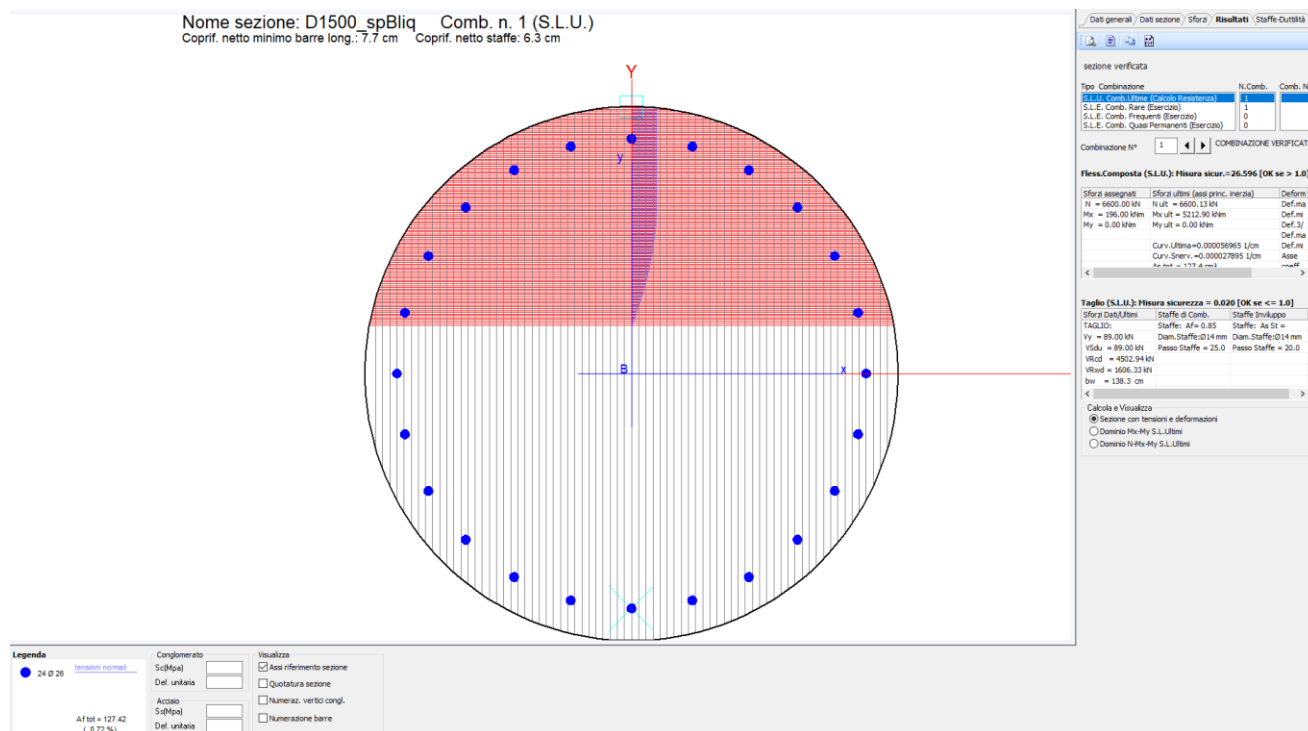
Verifica strutturale palo D1500mm a 16 m da testa palo – spalla B – con liquefazione
